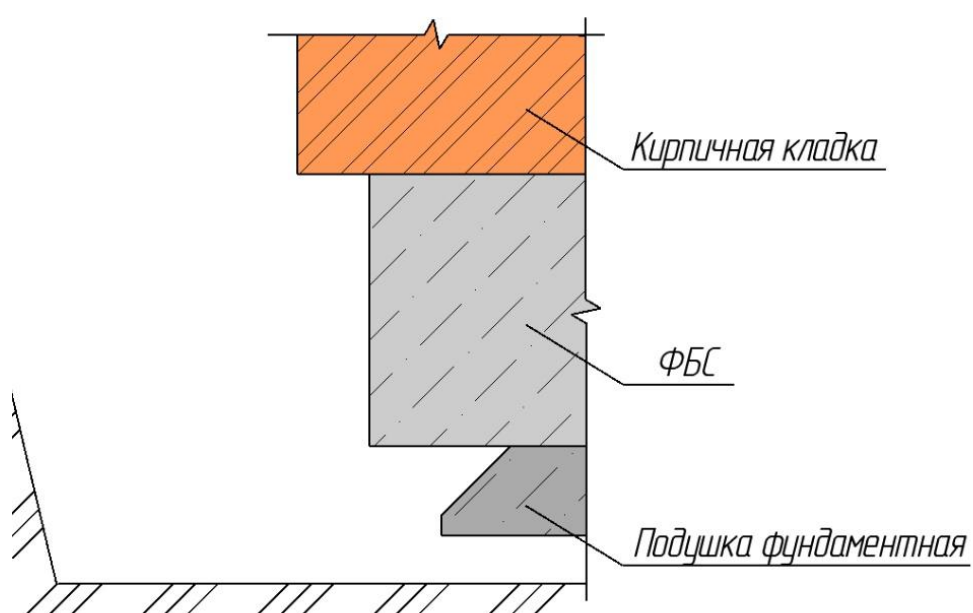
Узел после обнажения подошвы деформированного фундамента
